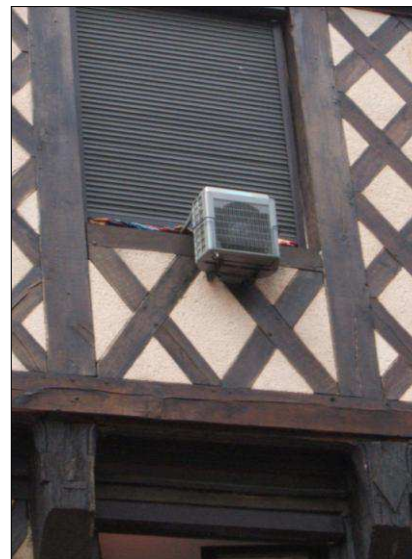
Machinerie en façade d'un immeuble classé, Place Gordaine
